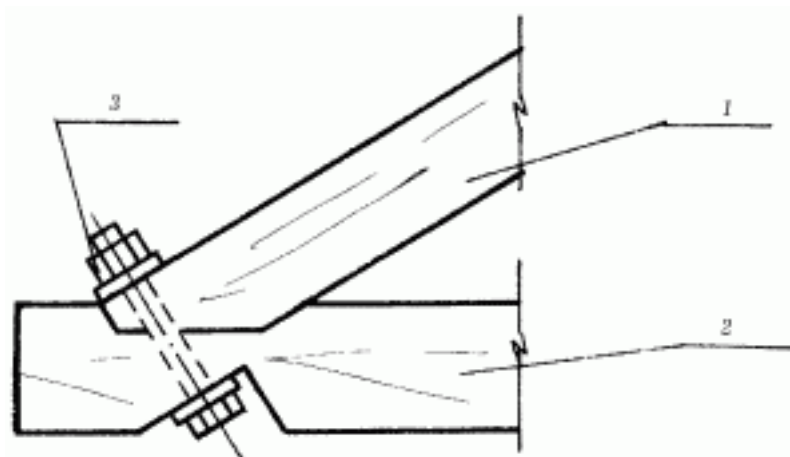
(продолжение). Соединение стропил болтом и хомутом: 1 – стропильная нога; 2 – затяжка; 3 – болт.
